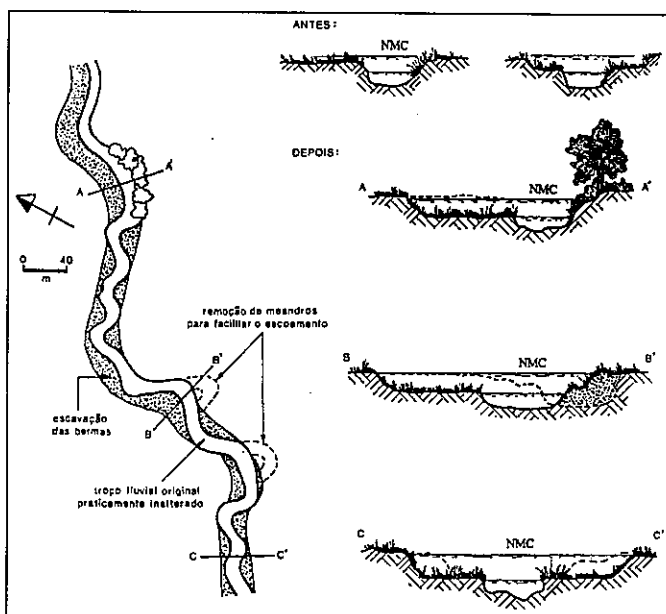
Plano longitudinal e cortes transversais de canais de secção composta (adapt. Lewis e Williams, 1984).
